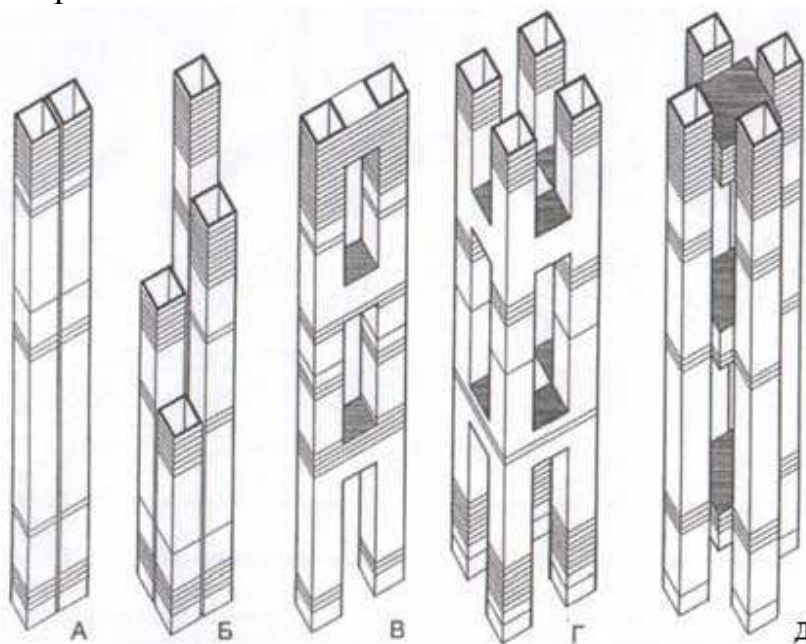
Конструктивные схемы высотных зданий на основе труб четырехугольного сечения с применением открытых объемов внутри здания: а, б) прямое примыкание стена к стене; в, г, д) не прямое соединение с помощью мостовых элементов
